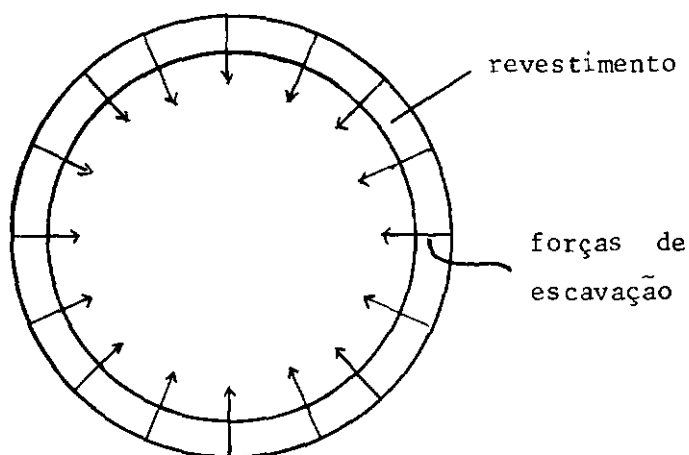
Túnel escavado em uma etapa com instalação imediata do revestimento após a escavação. Escavação por couraça ("shield").
